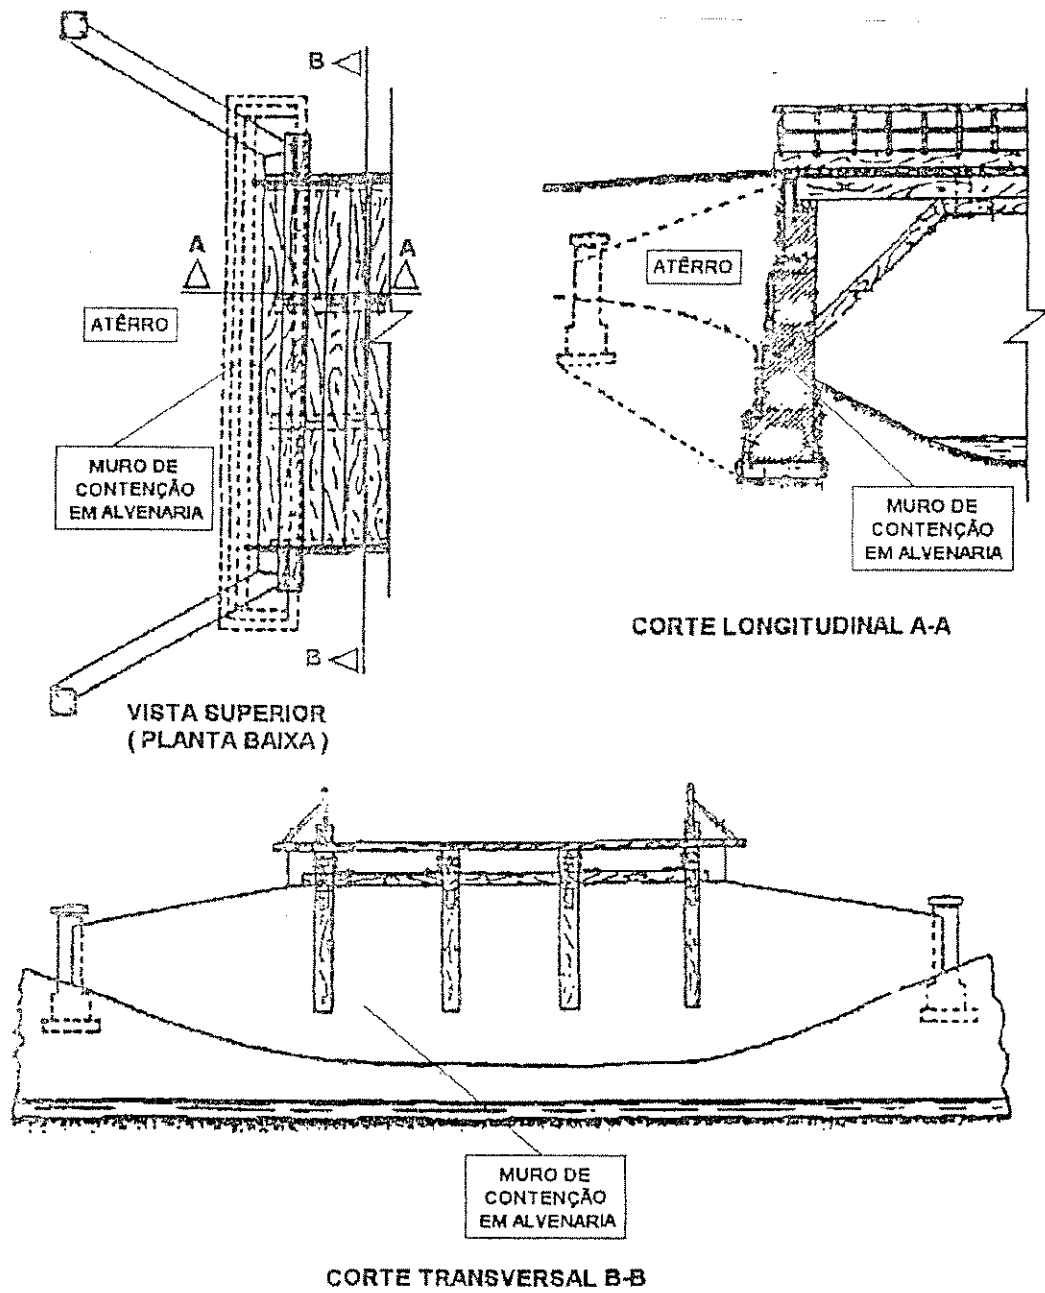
Fundação em Muro de Alvenaria(Fonte: LOGSDON *et ali*, 1997)
